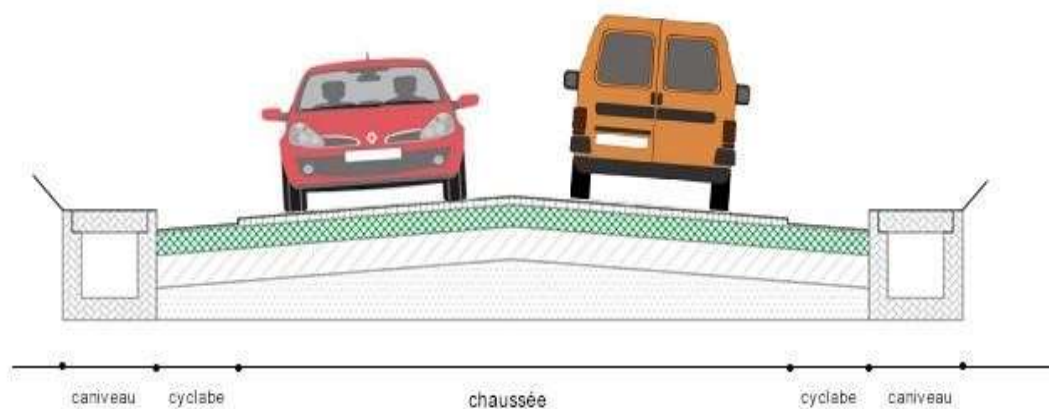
1 : Profil en travers type d'une chaussée [2]
